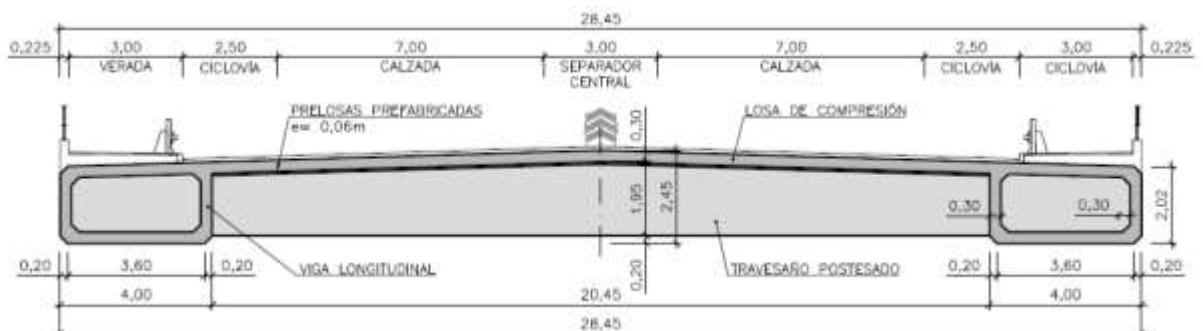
Sección tipo del tablero por travesaños intermedios
